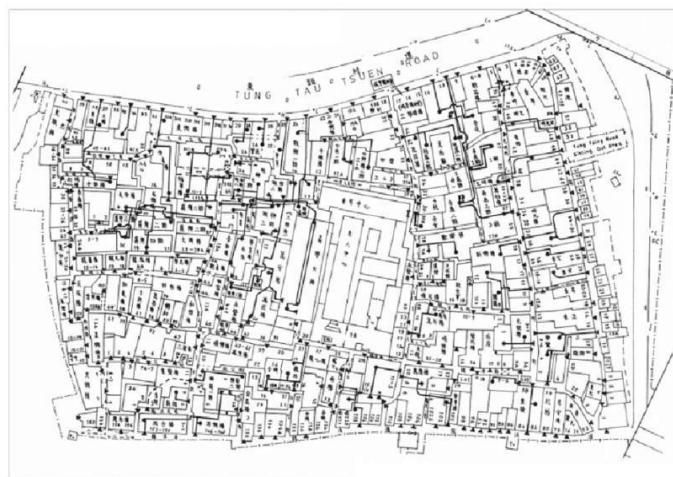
Planta baixa da cidade de Kowloon, 1985. Fonte: Kai Fong Association.
